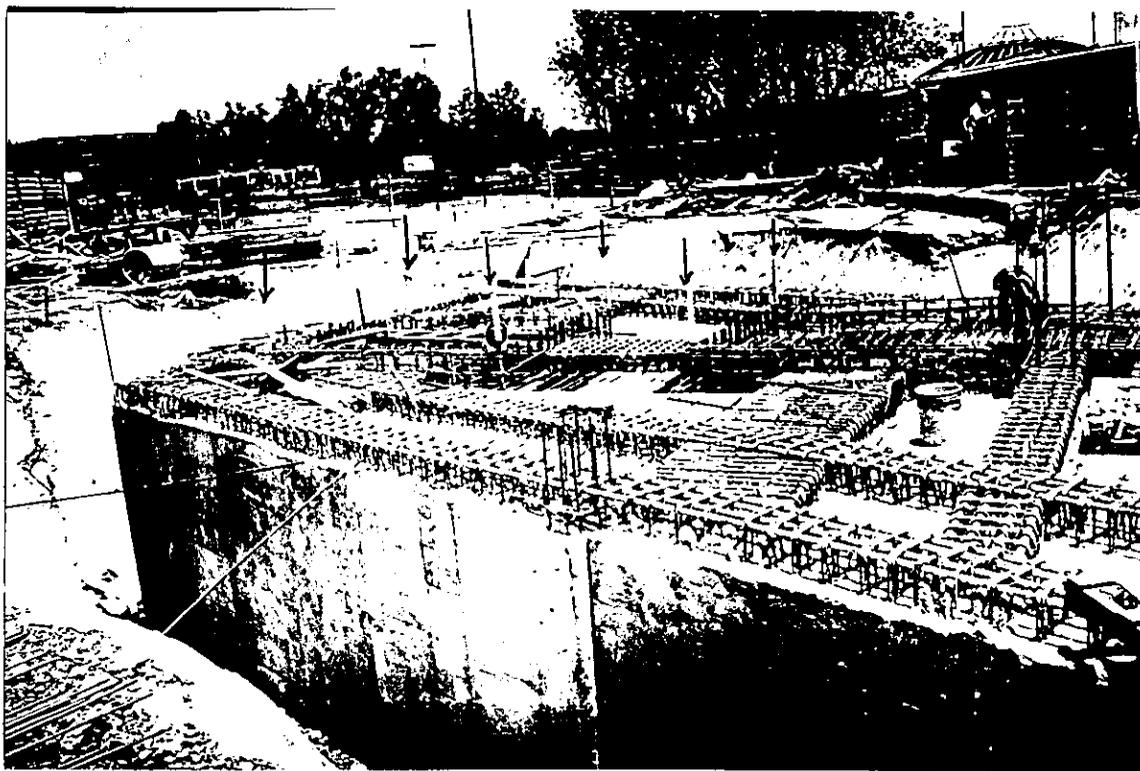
Cajón de cimentación previo al colado de la losa tapa, se pueden apreciar los pernos que se conectarán alas columnas prefabricadas.
